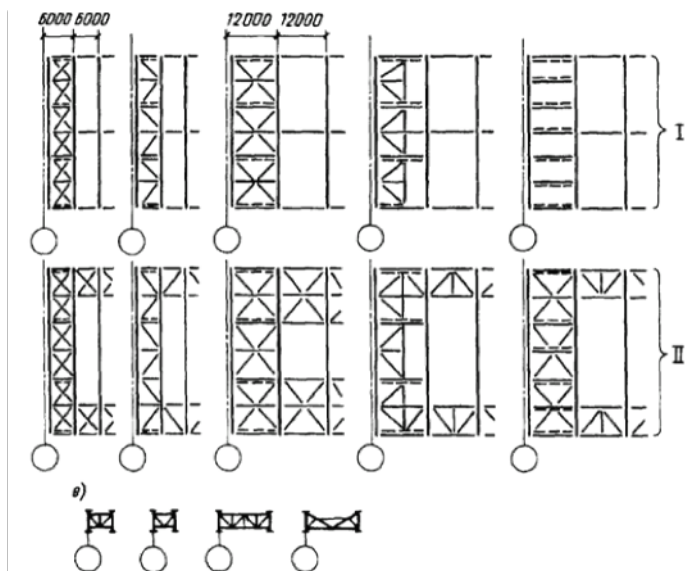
Связи покрытия по нижнему (I) и по верхнему (II) поясам
